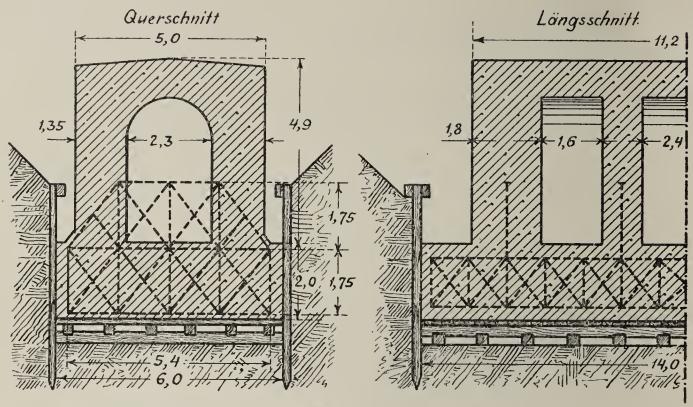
und 325. Brückenwiderlager im Laibacher Moor.
